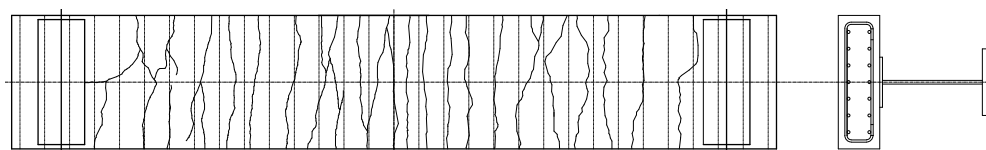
孔あき鋼板ジベルのひび割れ発生状況
